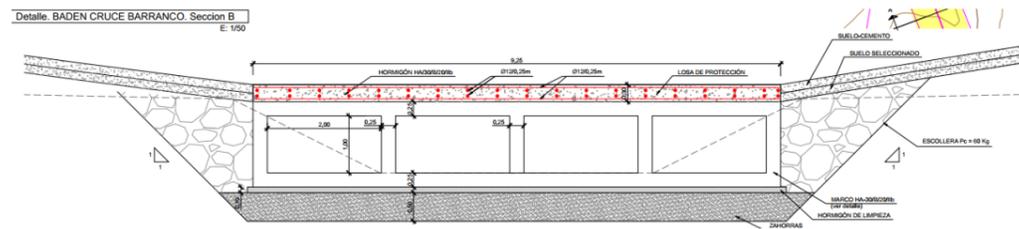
Detalles paso inferior baden inundable en camino acceso Los Almagros
